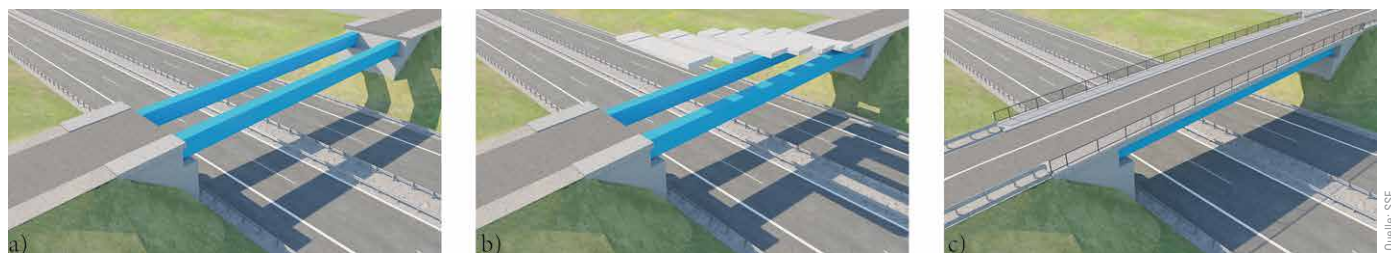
Schematischer Ablauf beim Bau einer Brücke in VSM-Bauweise: a) Einbau der Stahllängsträger, b) Verlegen der Fahrbahnsegmente und c) Fertigstellung des Überbaus
